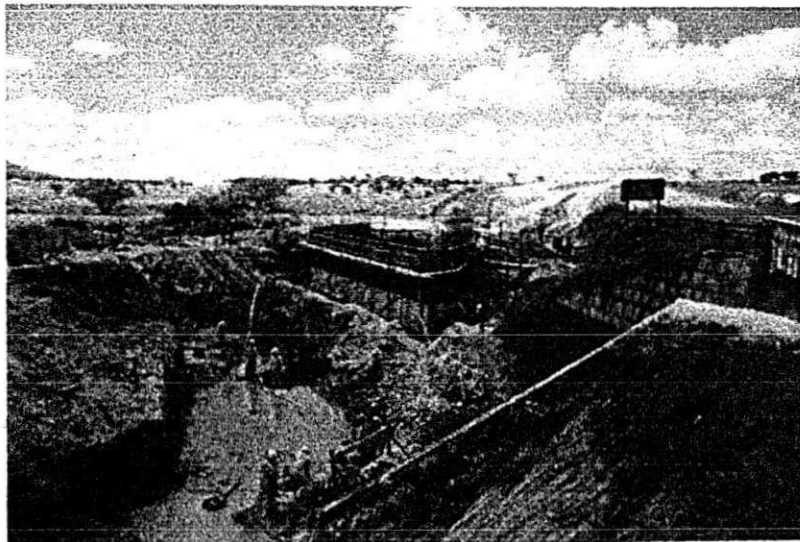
Detalhe da armação dos painéis para a concretagem da Ponte sobre o Riacho do mel na estaca 1159.
